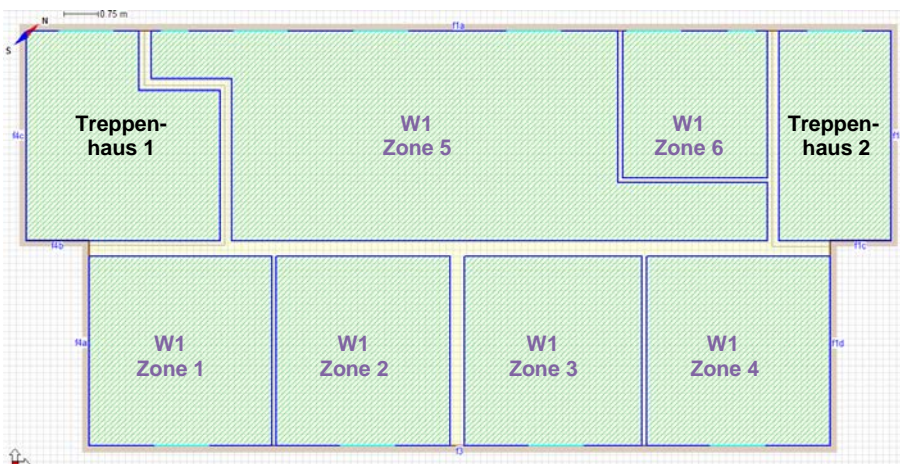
Grundriss des aufgebauten Wohngeschossmodells „Altbau geschützt“ mit Zonenaufteilung.
